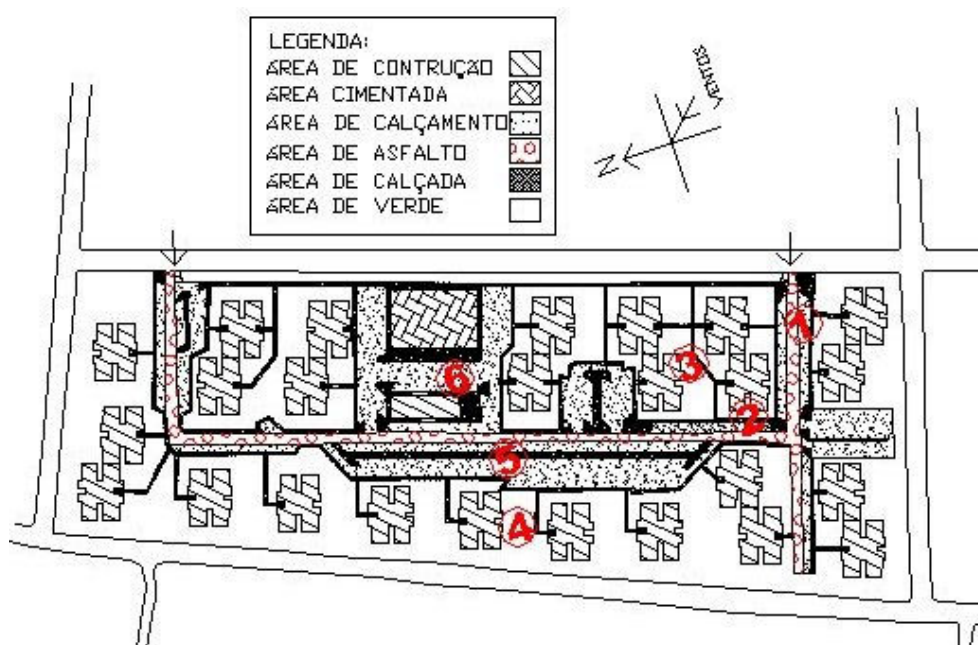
Planta de situação Condomínio Santa Marta e pontos de medições
